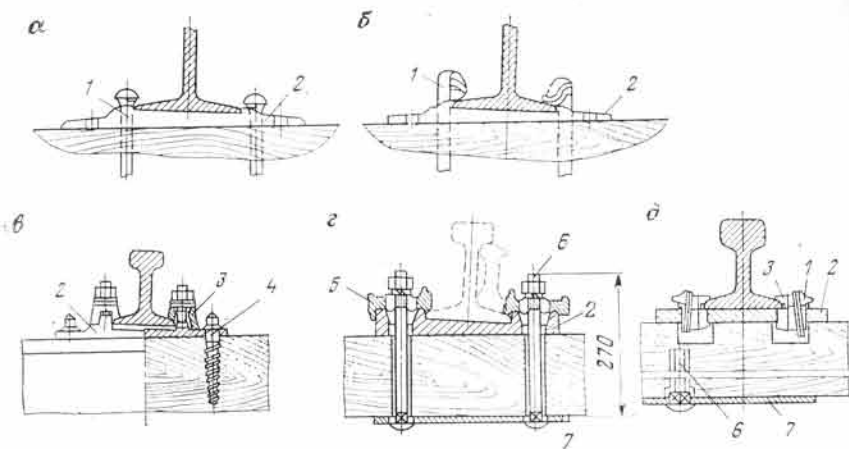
Крепление рельсов к шпалам обычными (а) и пружинными (б) костылями, шурупами (в), болтами и двухребордчатыми подкладками с прижимами (г), болтами клинового типа (д): 1 — костыль; 2 — подкладка; 3 — прижим; 4 — шуруп; 5 — двухребордчатая накладка; 6 — болт; 7 — нижняя подкладка
